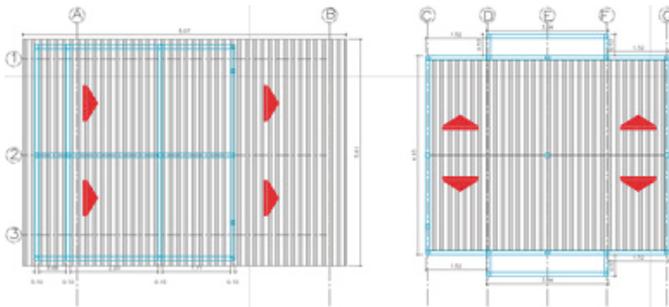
Planta de pendientes de techo vivienda modular sostenible (modelo 2D)
